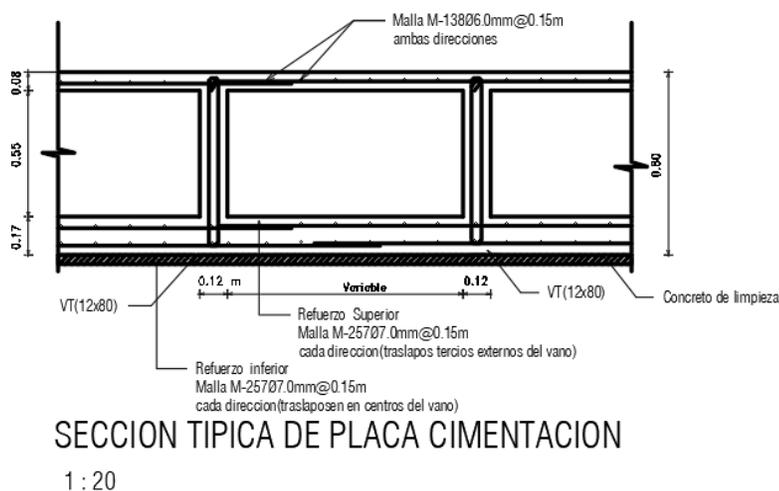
Sección típica de placa de cimentación. Constructora Vivir Bien SAS (2020)
